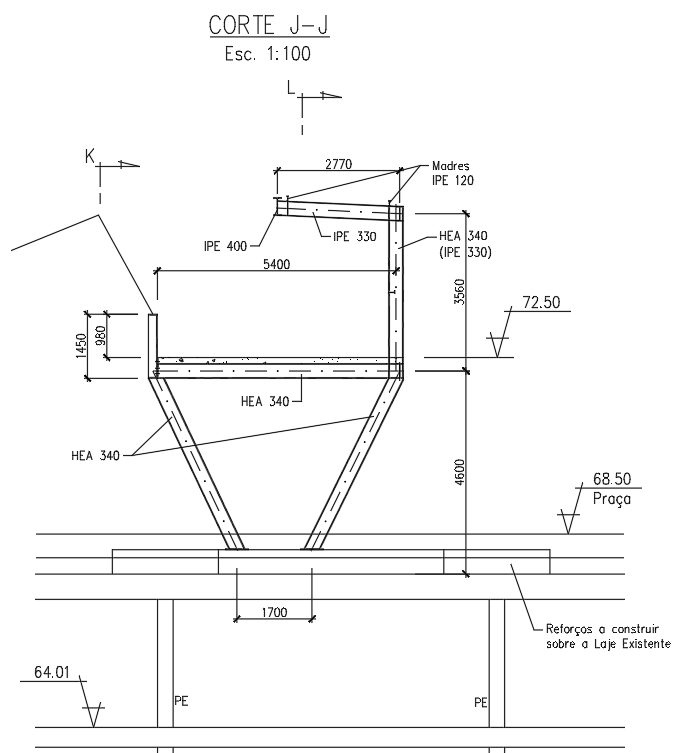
Passadiço de acesso à estação do Metro: Corte transversal.
